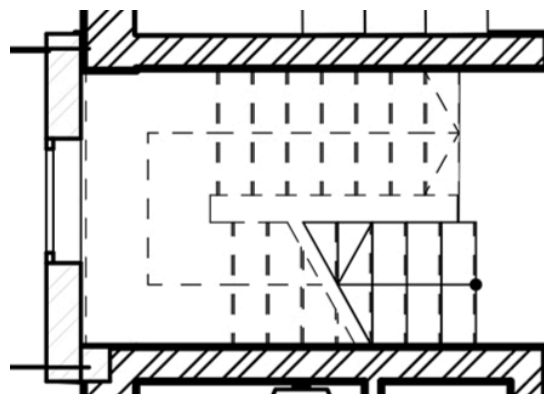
Фрагмент плану з вертикальними комунікаціями.
